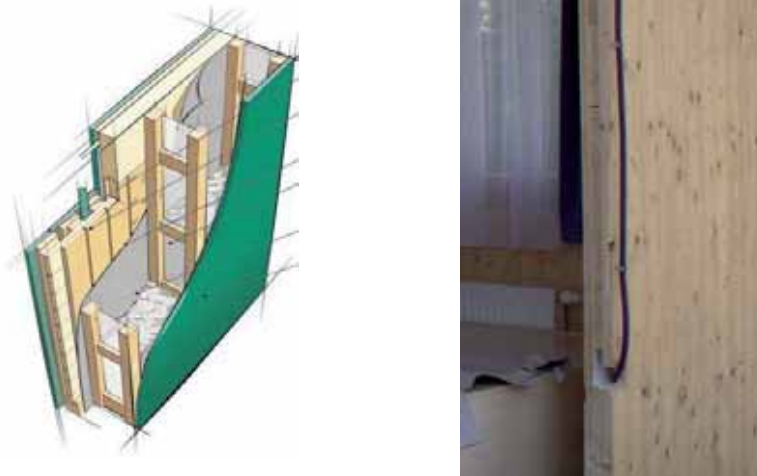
links: U*psi F-Element hochwärmegedämmte Lignotrend-Massivholzwand, rechts: Elektroinstallationen durch KLH Wand.
